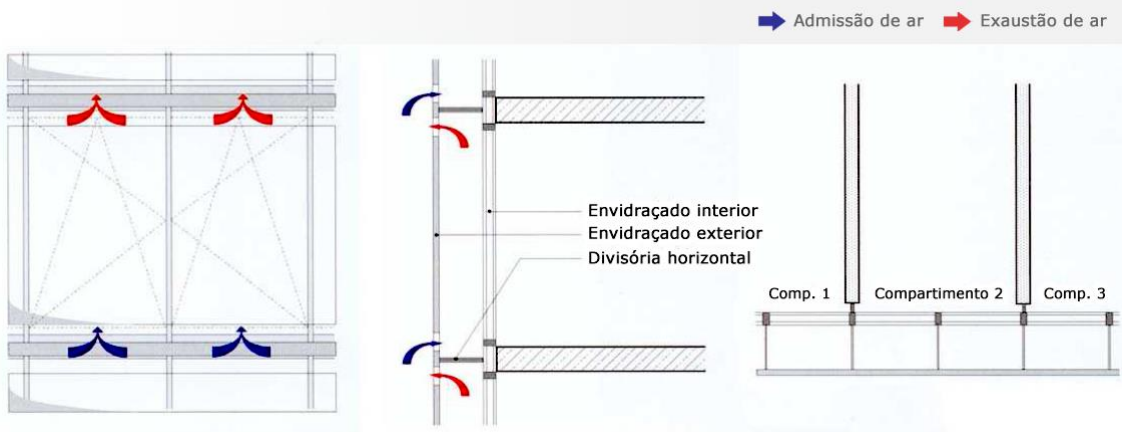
Geometria e esquema geral de ventilação de uma fachada do tipo “Confinada”
